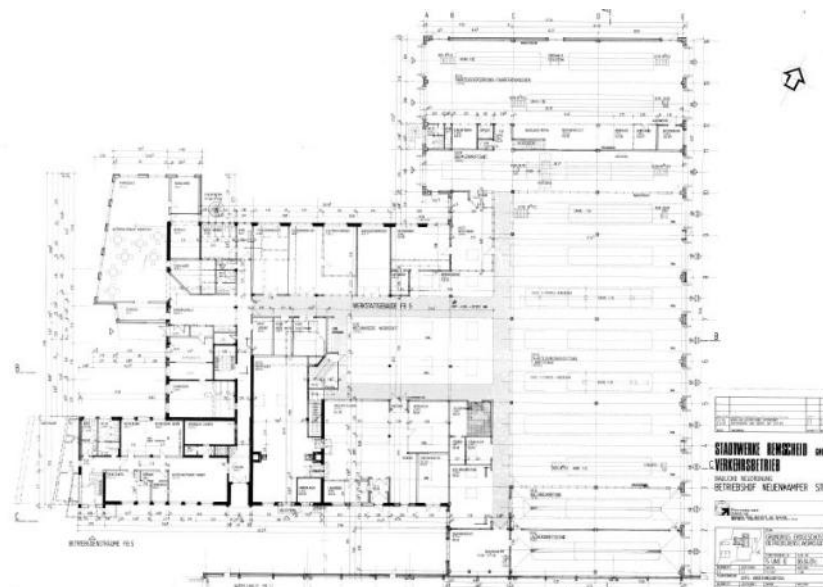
FB5+6 Grundriss EG Bau 06.04.01 (Quelle: EWR GmbH)
